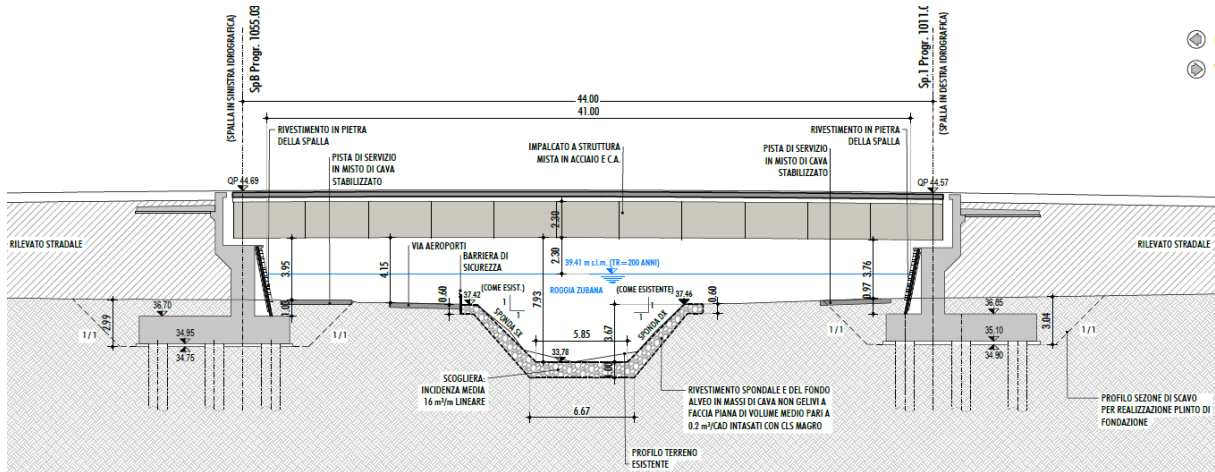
ROGGIA ZUBANA: SEZIONE A-A IN ASSE ALLA STRADA DI PROGETTO (VISTA DA MONTE)
